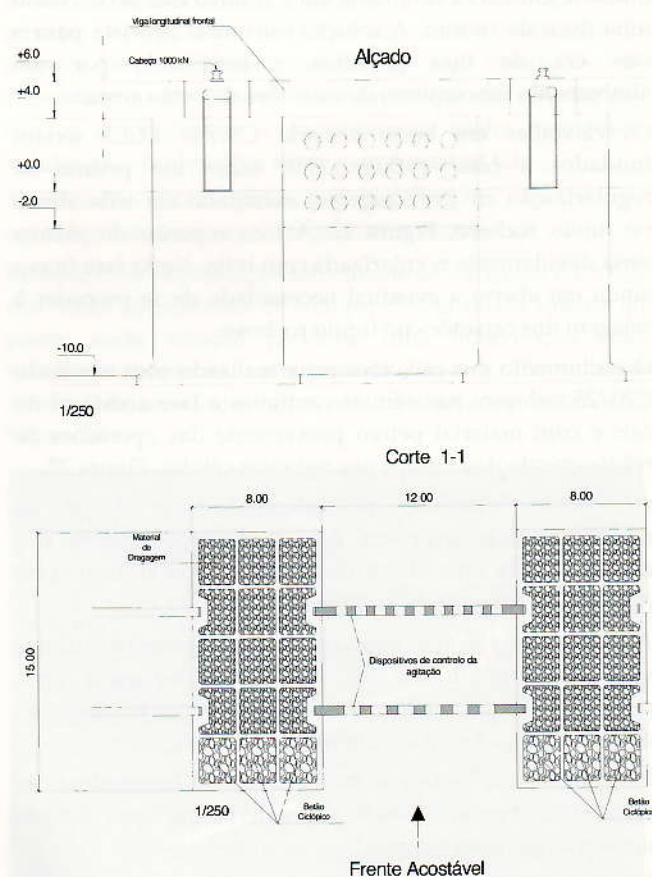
Alçado e corte-tipo do cais previsto para o terminal de passageiros na 3.ª fase do Estudo Prévio, evidenciando elementos verticais de controlo da agitação, IHRH (2006).
